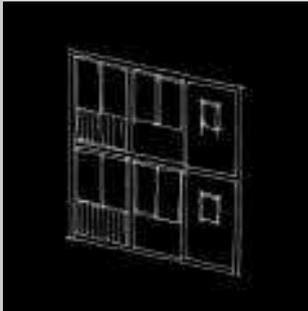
Aufteilung der einzelnen Fassaden, bei Anschlusswänden zu Nachbargebäuden können diese unter „Fassade 3“ oder „Fassade 4“ erfasst werden.
